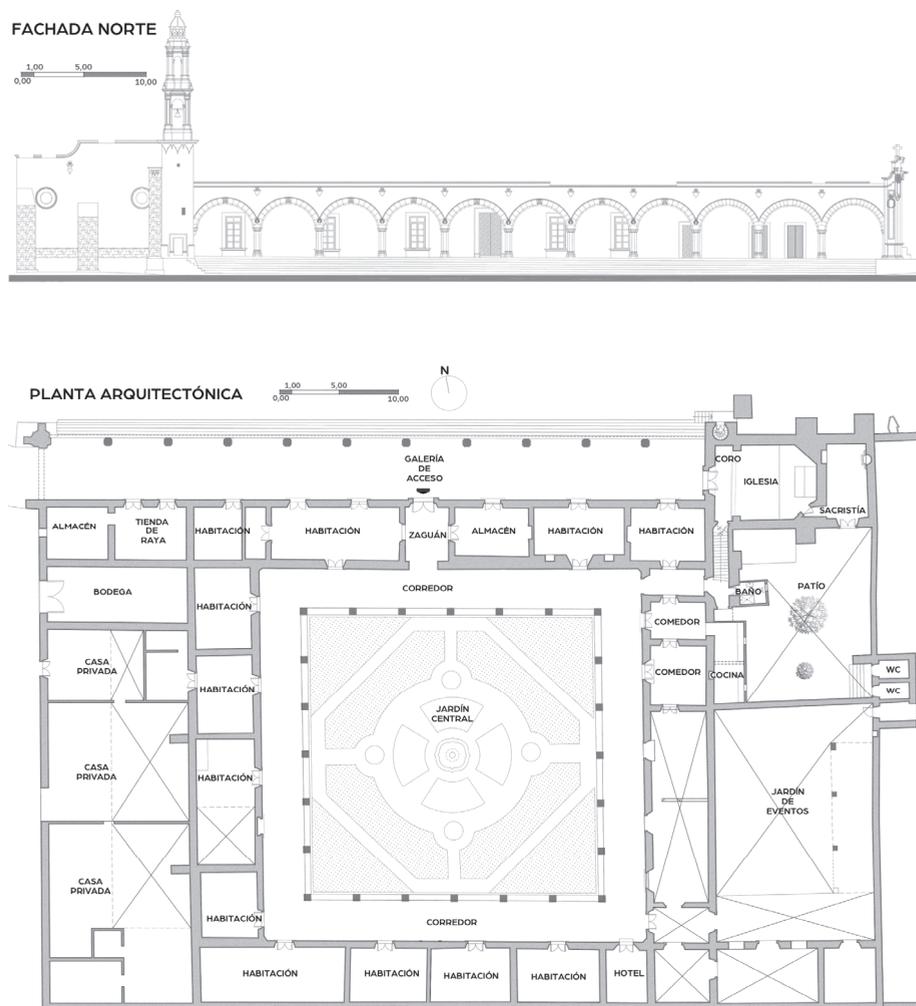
Planta y fachada de la casa de la hacienda. (Fuente: Elaboración propia).
